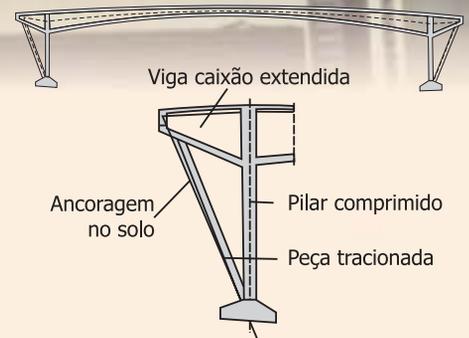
Reforço aplicado em uma viga contínua, utilizando-se dimensionamento com conseqüente deformação.
